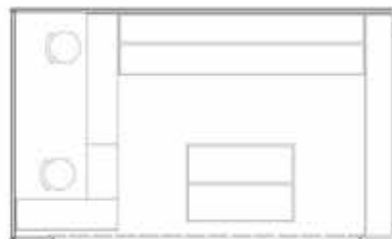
Boxes de 15m<sup>2</sup> - Layout
